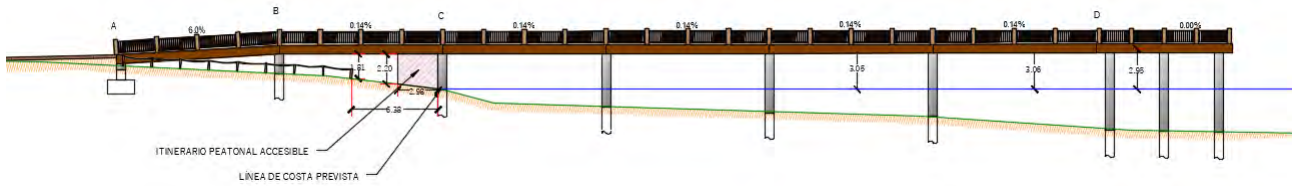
Captura del Plano 02 Perfil longitudinal Alternativa 2 (Anexo 1 Planos).
